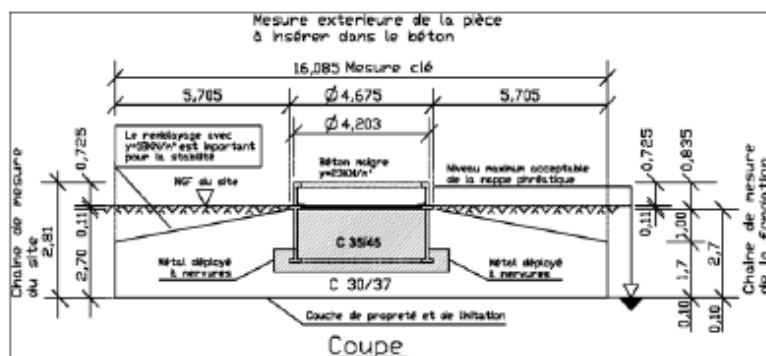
Coupe schématique d'une fondation Vestas V112 – vue de face (Source : Vestas)¹
